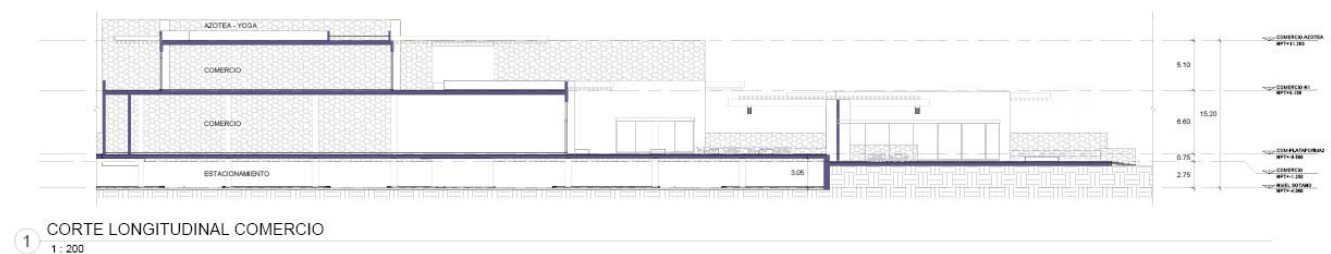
Sección longitudinal del proyecto. A la izquierda colinda con lote CP-1; a la derecha, con vialidad.
